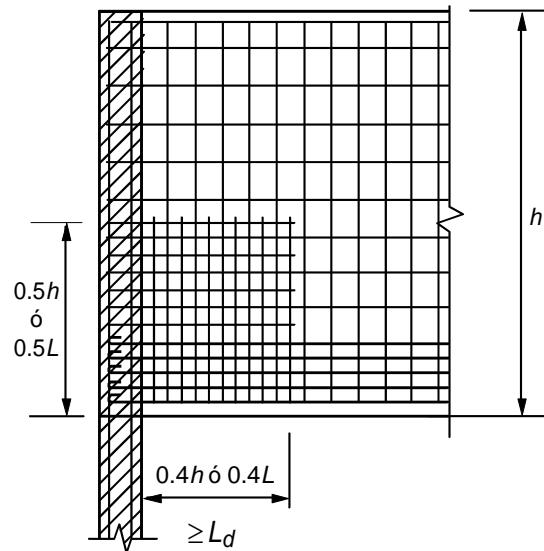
Refuerzo complementario en una zona de apoyo directo de una viga diafragma no atiesada
